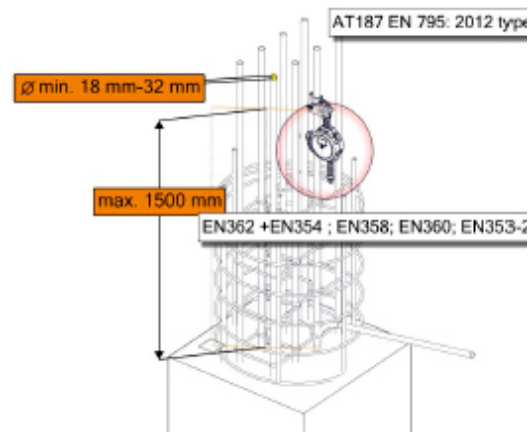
Installazione del dispositivo di collegamento-dissipazione direttamente sul punto di ancoraggio
